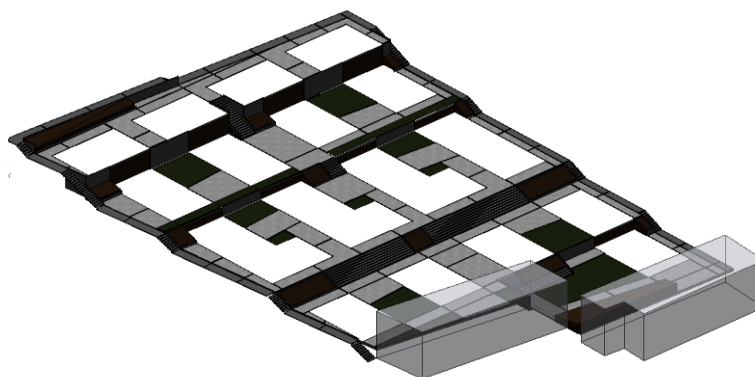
Vista 3d Implantación, Recorridos peatonales. Fuente: Propia
